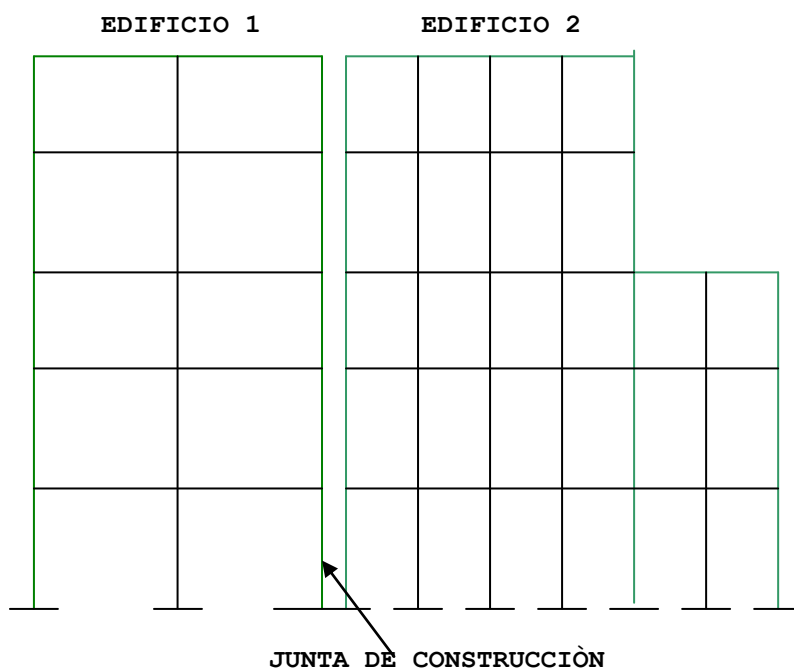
DISPOSICIÓN CORRECTA DE UNA JUNTA DE CONSTRUCCIÓN
